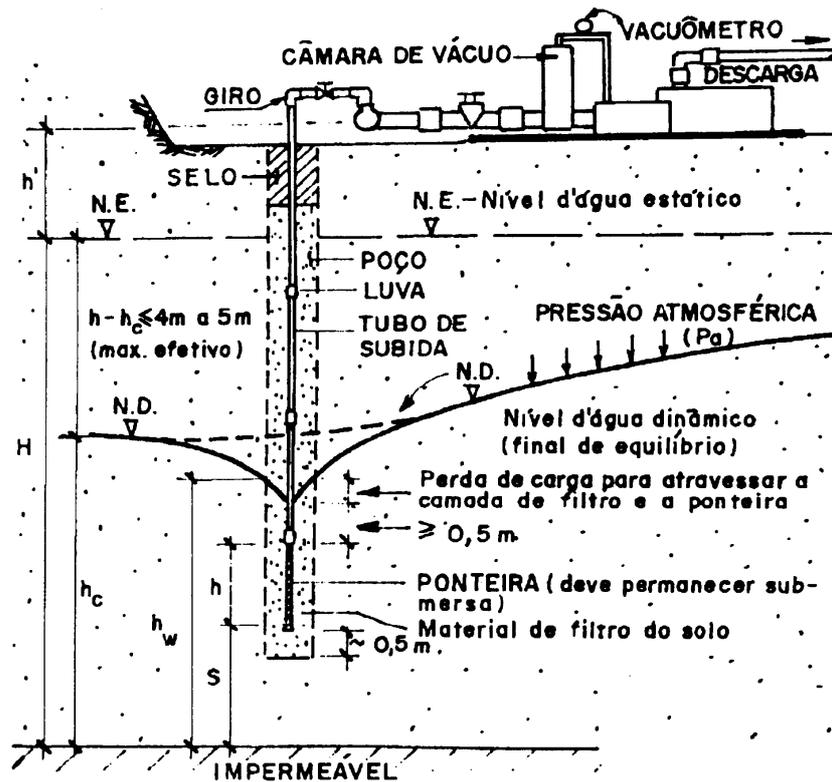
Sistema de rebaixamento por ponteiros (Hachich e outros,1998).
